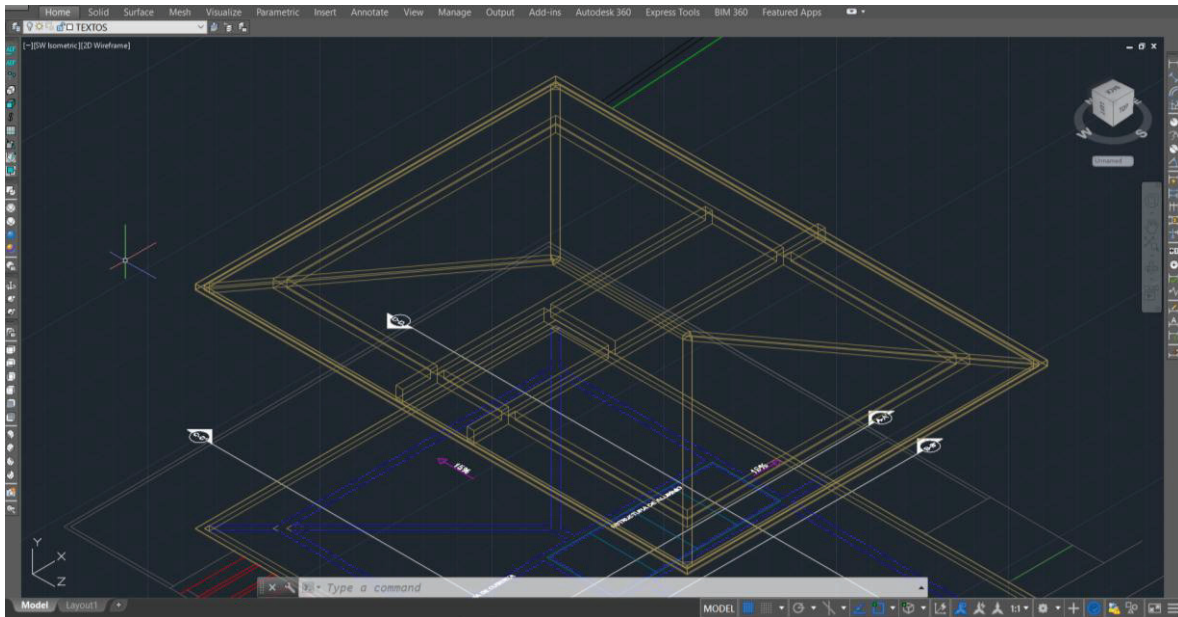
Captura de pantalla de las vigas y cubierta.
